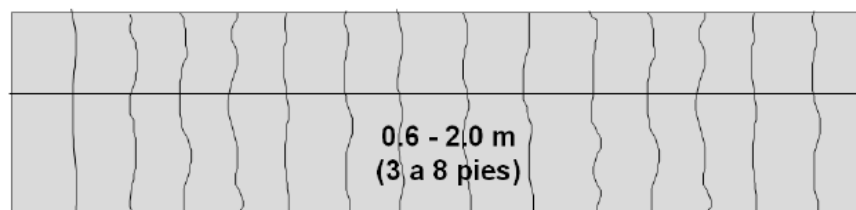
Esquema de pavimentos de concreto reforzado con juntas.
